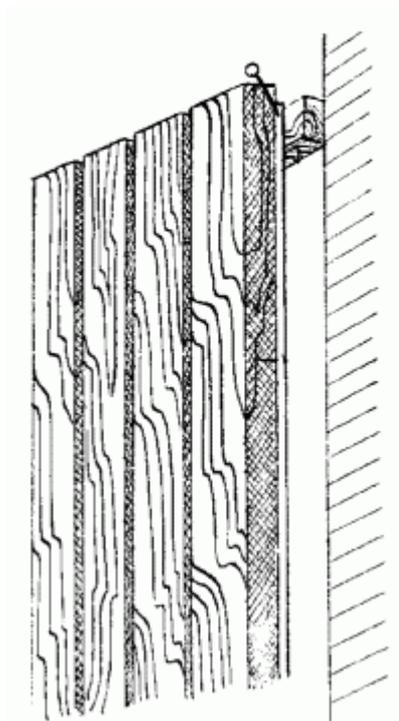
Монтаж панелей из древесины на деревянные бруски.
